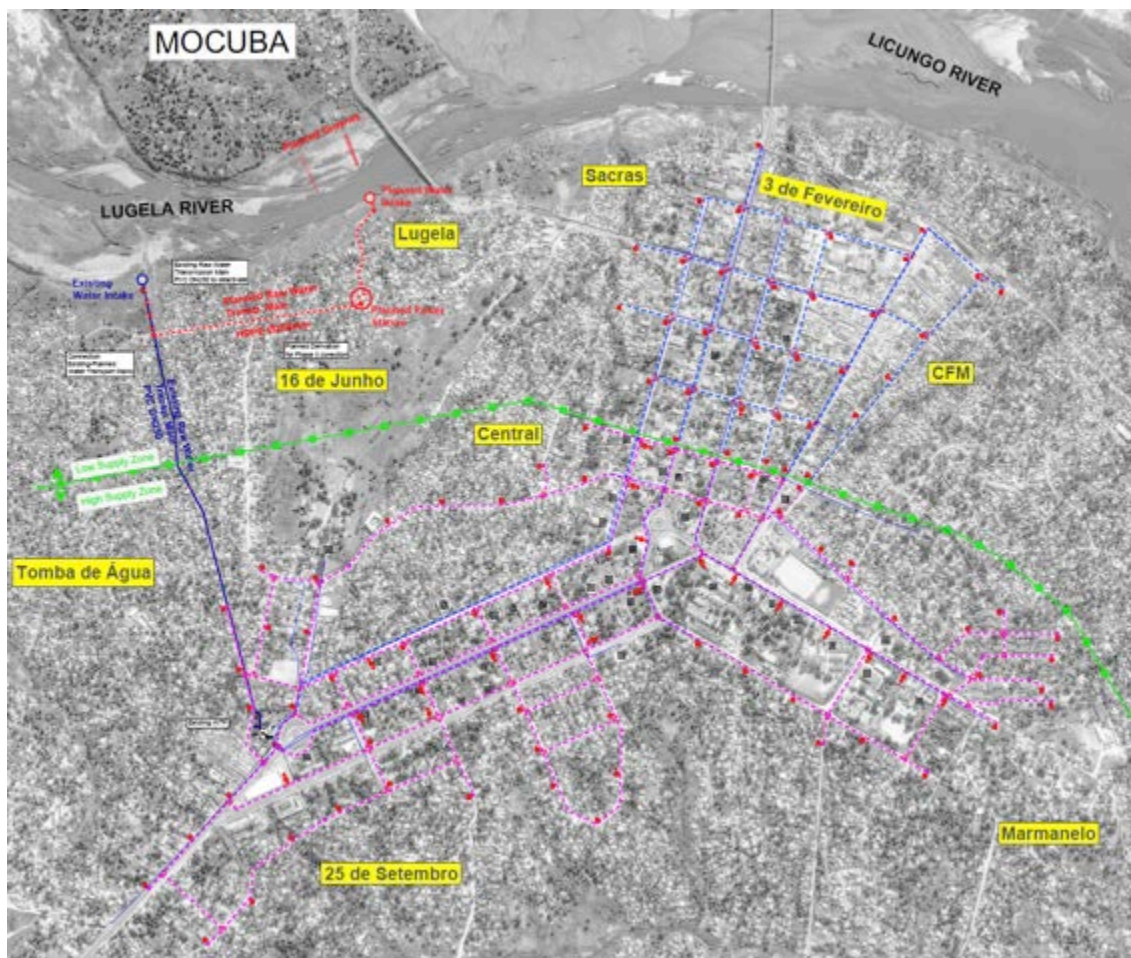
Infraestruturas planeadas para construir no âmbito da Fase I do Projecto
